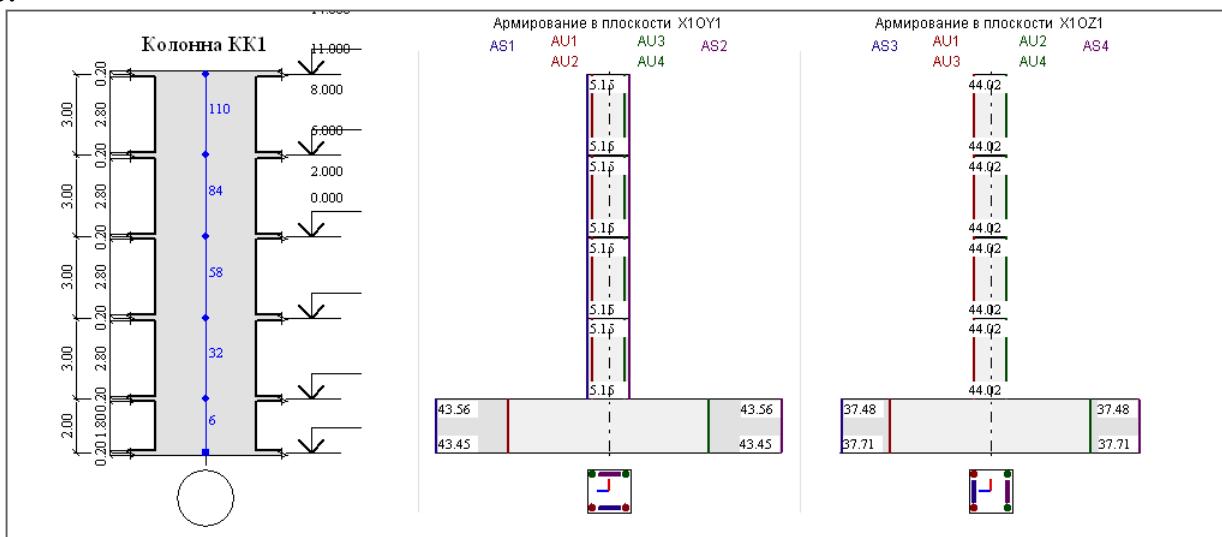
Армирование колонны 1-5 этажей схемы. Поперечное и продольное армирование соответственно.
